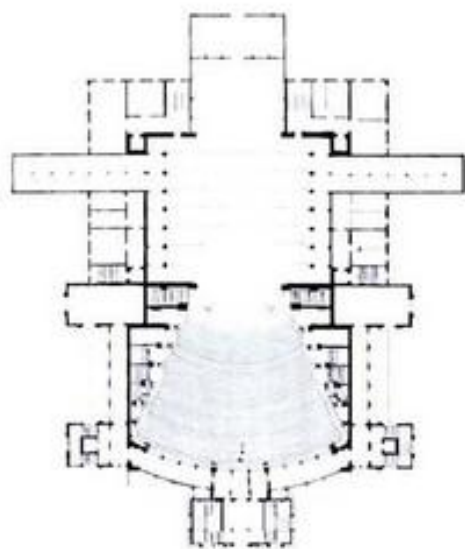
Planta de um teatro pré-Wagner¹⁹.
